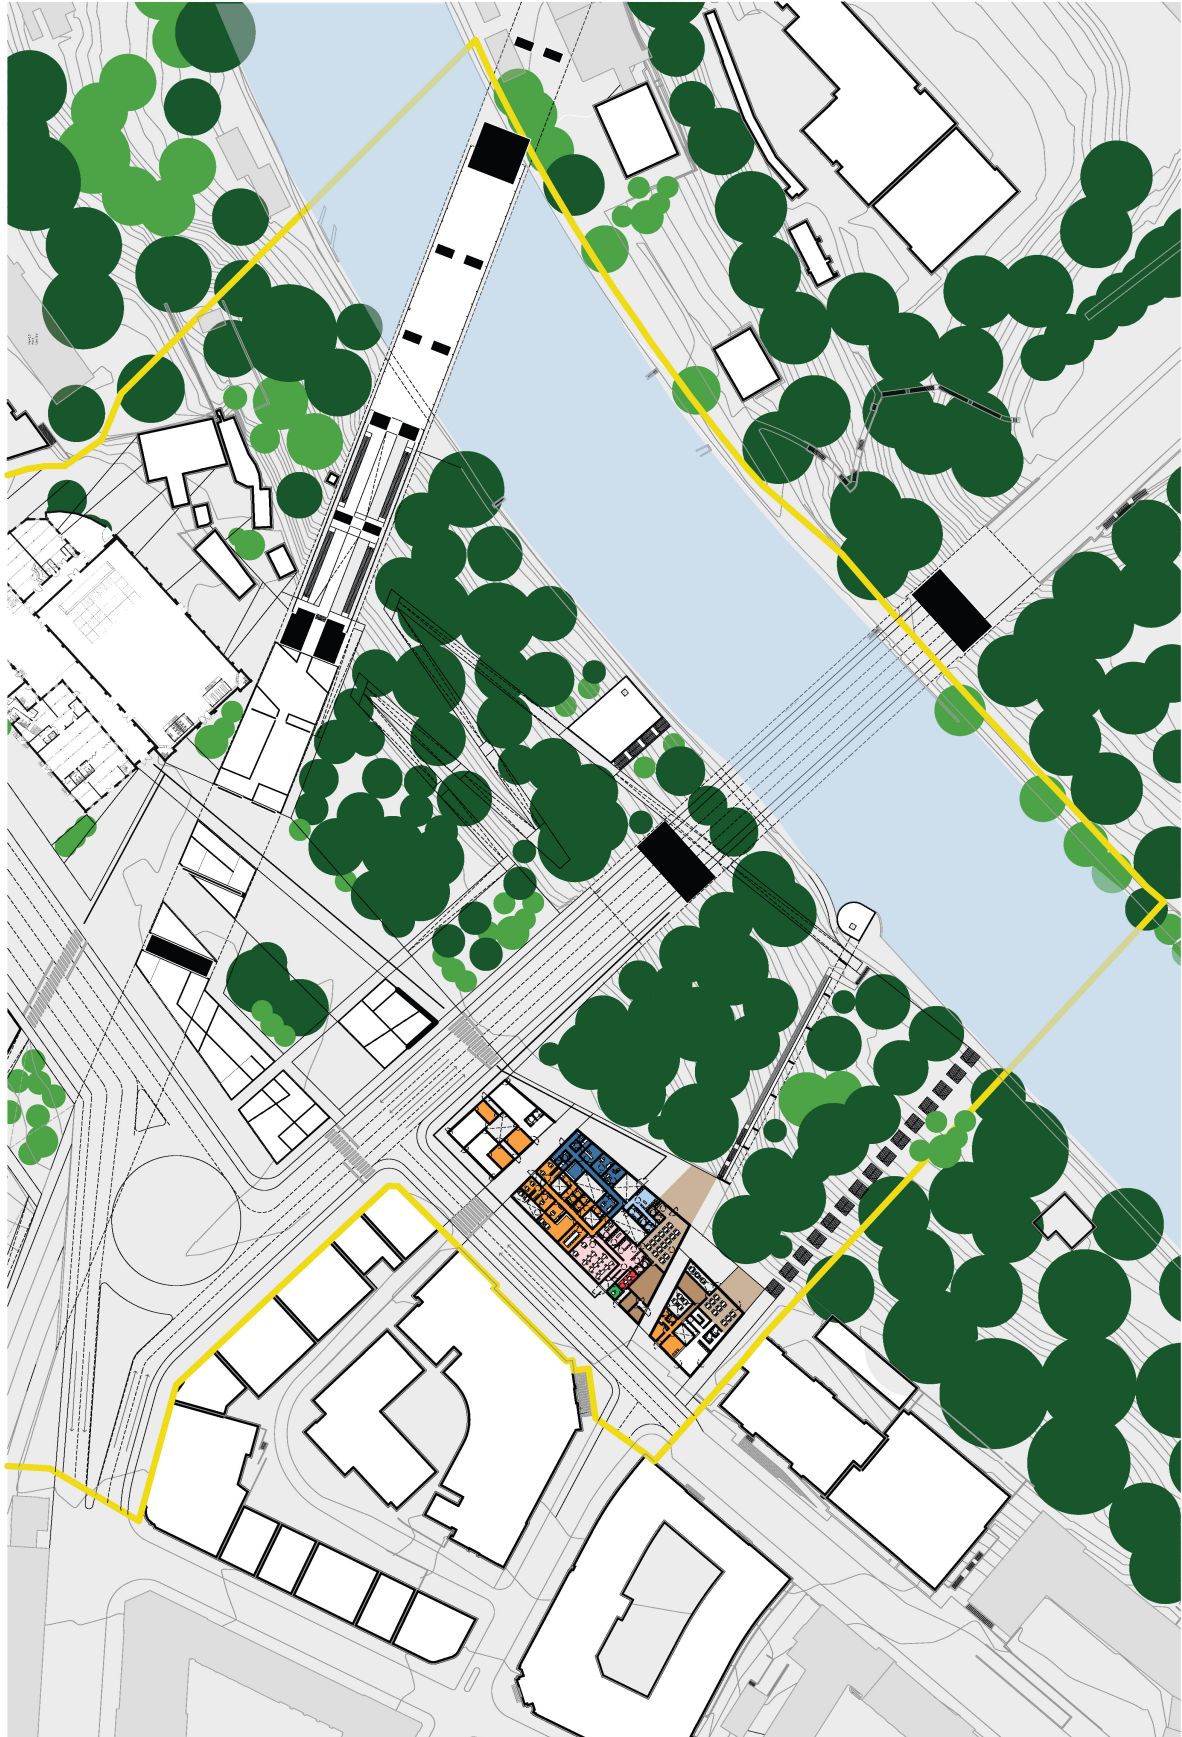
Planta de Implantação do Edifício a Pormenorizar
